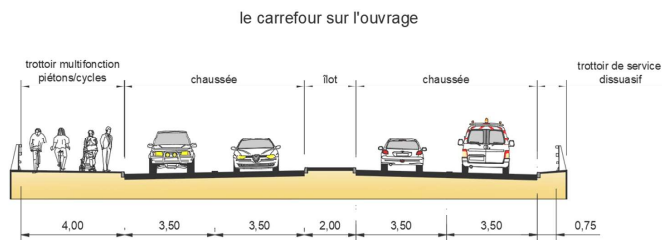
Profil en travers type du barreau pour les variantes 1 et 2
